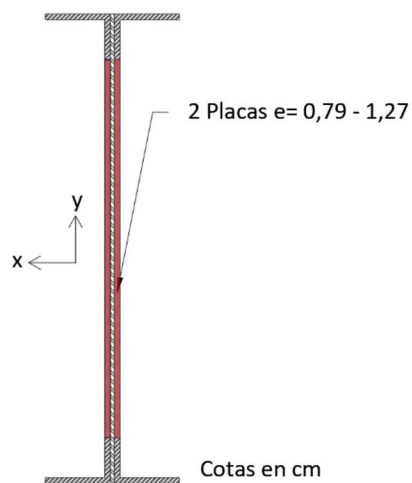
Sugerencia de reforzamiento para las vigas de piso.
